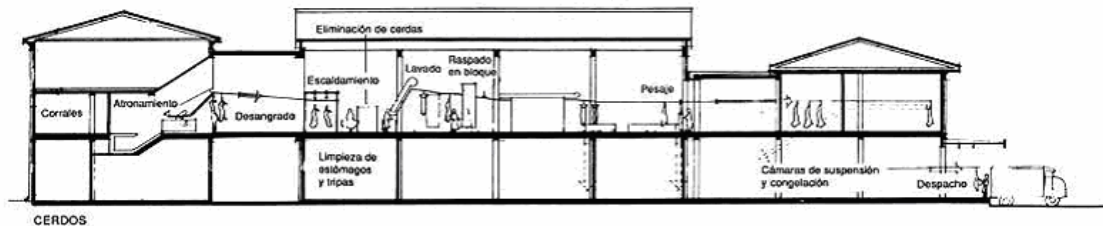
Matadero de doble planta (Fao., 1993).
